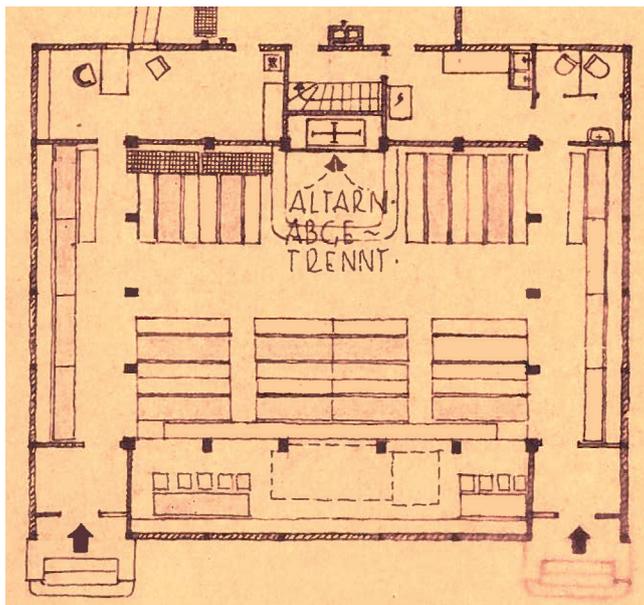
Grundriss Friedenskirche Neufahrn, Nutzung als Gemeindesaal, Otto Bartning, Januar 1949, M ca. 1:200
